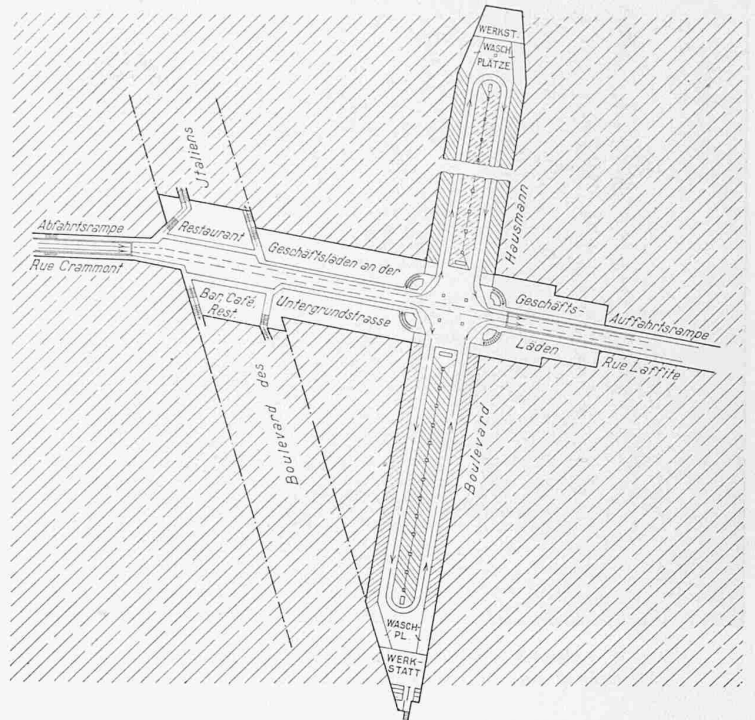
Vorschlag für eine Untergrund-Garage in Paris unter dem Schlussstück des Boulevard Haussmann beidseits der Rue Laffitte. — Masstab rund 1:3200.
